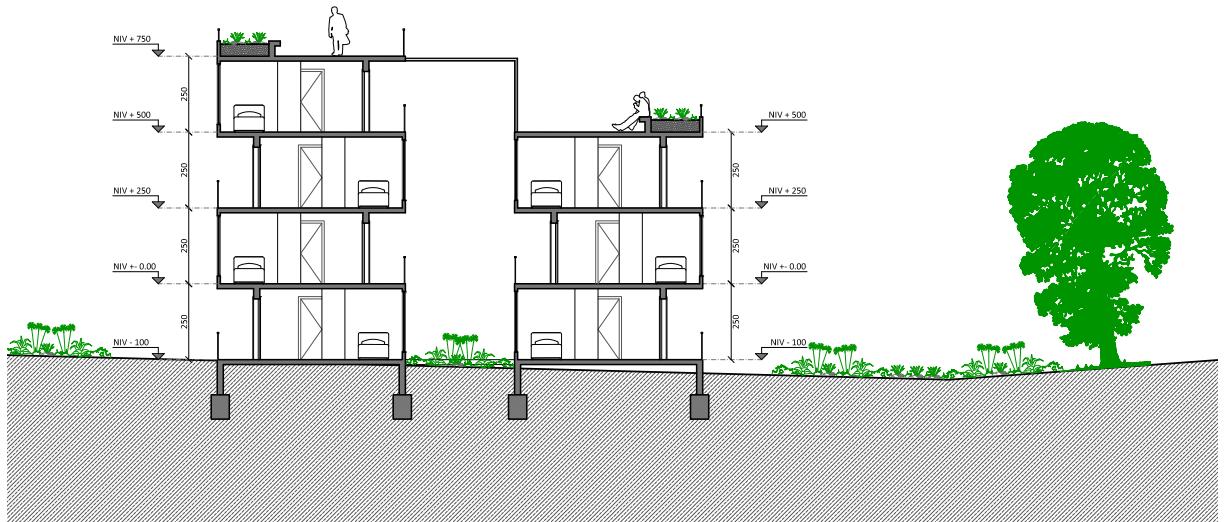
"Planta primer nivel"; Fig. 162 "Corte Transversal".
